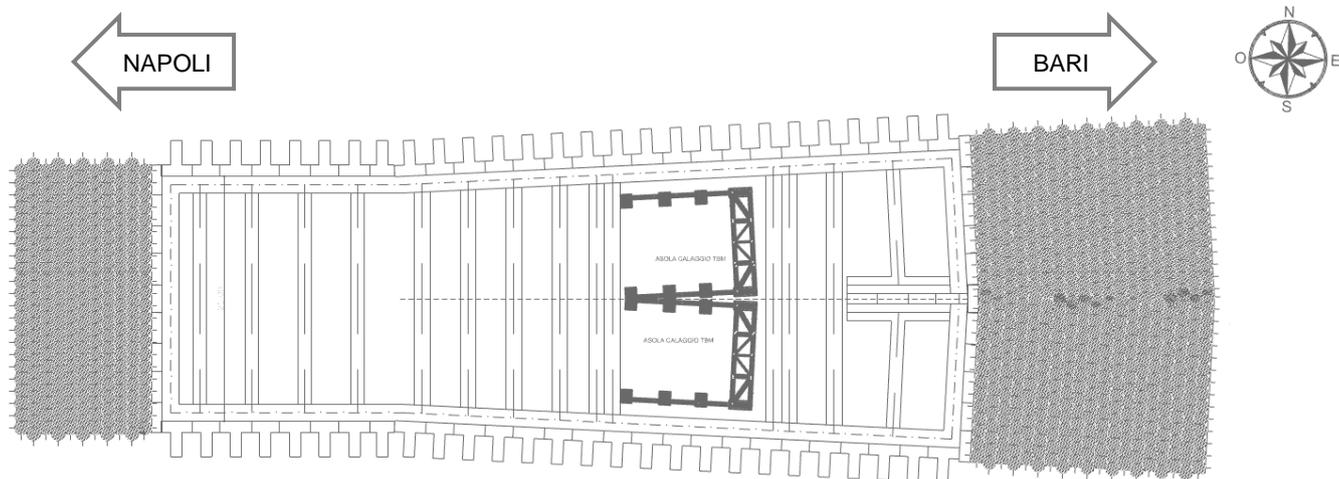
Planimetria pozzo di lancio TBM e retro-pozzo
